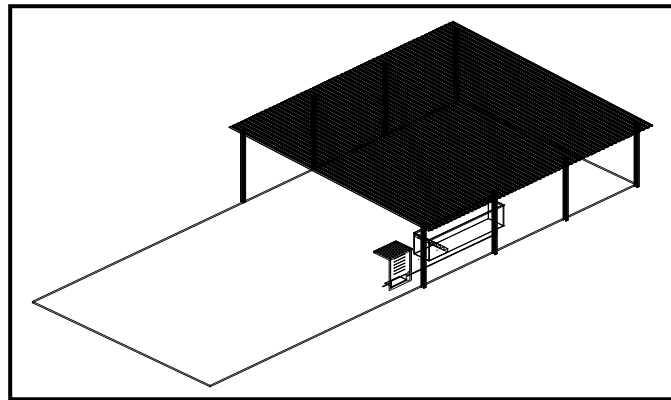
, Modelo de la losa y el techo (propuesto)
